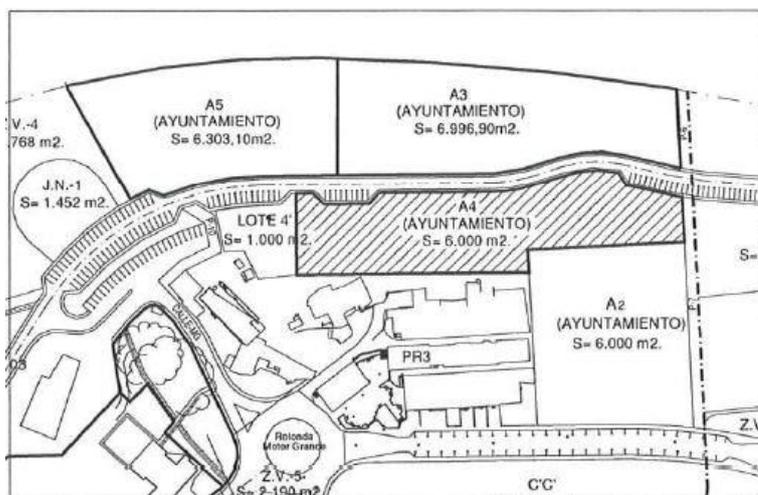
Plano de situación en el que se ubica el ámbito de ordenación del PAMU. Elaboración propia.
